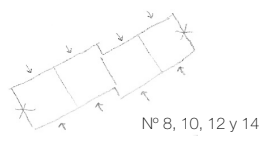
Bocetos en planta de la disposición de las construcciones situadas en la Rúa Moaña-Coia, nº 8, 10, 12 y 14 (autoría propia).
